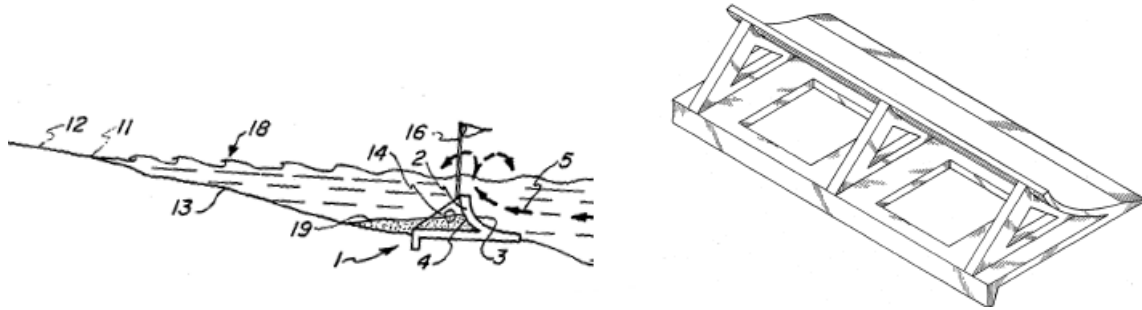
29. Muro prefabricado para la prevención de la erosión.
